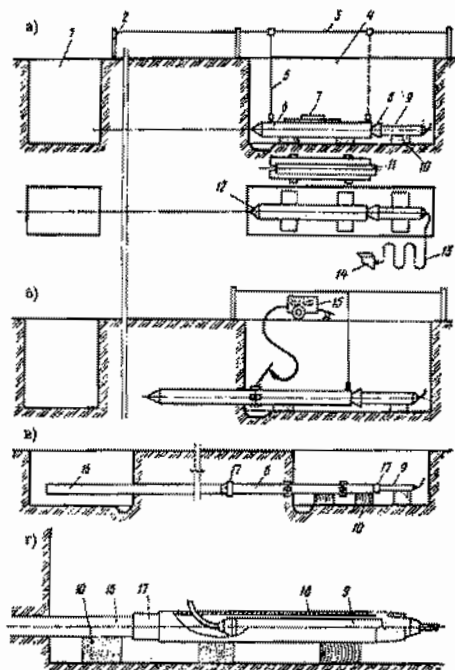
Схема прокола стальной трубы (футляра) с помощью пневмобойника: 1 - приемный приямок; 2 - вешки; 3 - шнур; 4 - входной приямок; 5 - отвес; 6 - головная секция забиваемой трубы; 7 - линейка с уровнем; 8 - насадка; 9 - пневмобойник; 10 - прокладка; 11 - секция труб; 12 - оголовок; 13 - шланг; 14 - компрессор; 15 - сварочный агрегат; 16 - извлекаемая труба; 17 - переходная втулка; 18 - приспособление для извлечения труб
